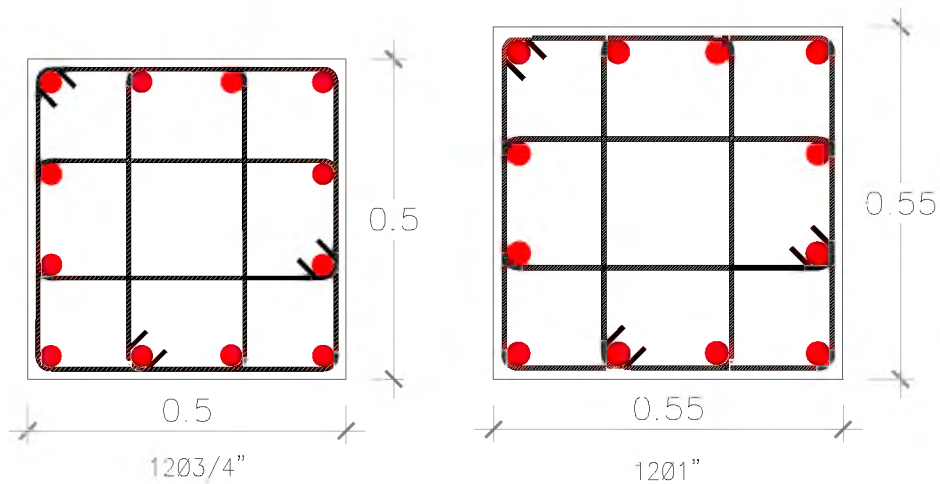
Sección y distribución de refuerzos longitudinales en las columnas CA1 y CB1.
